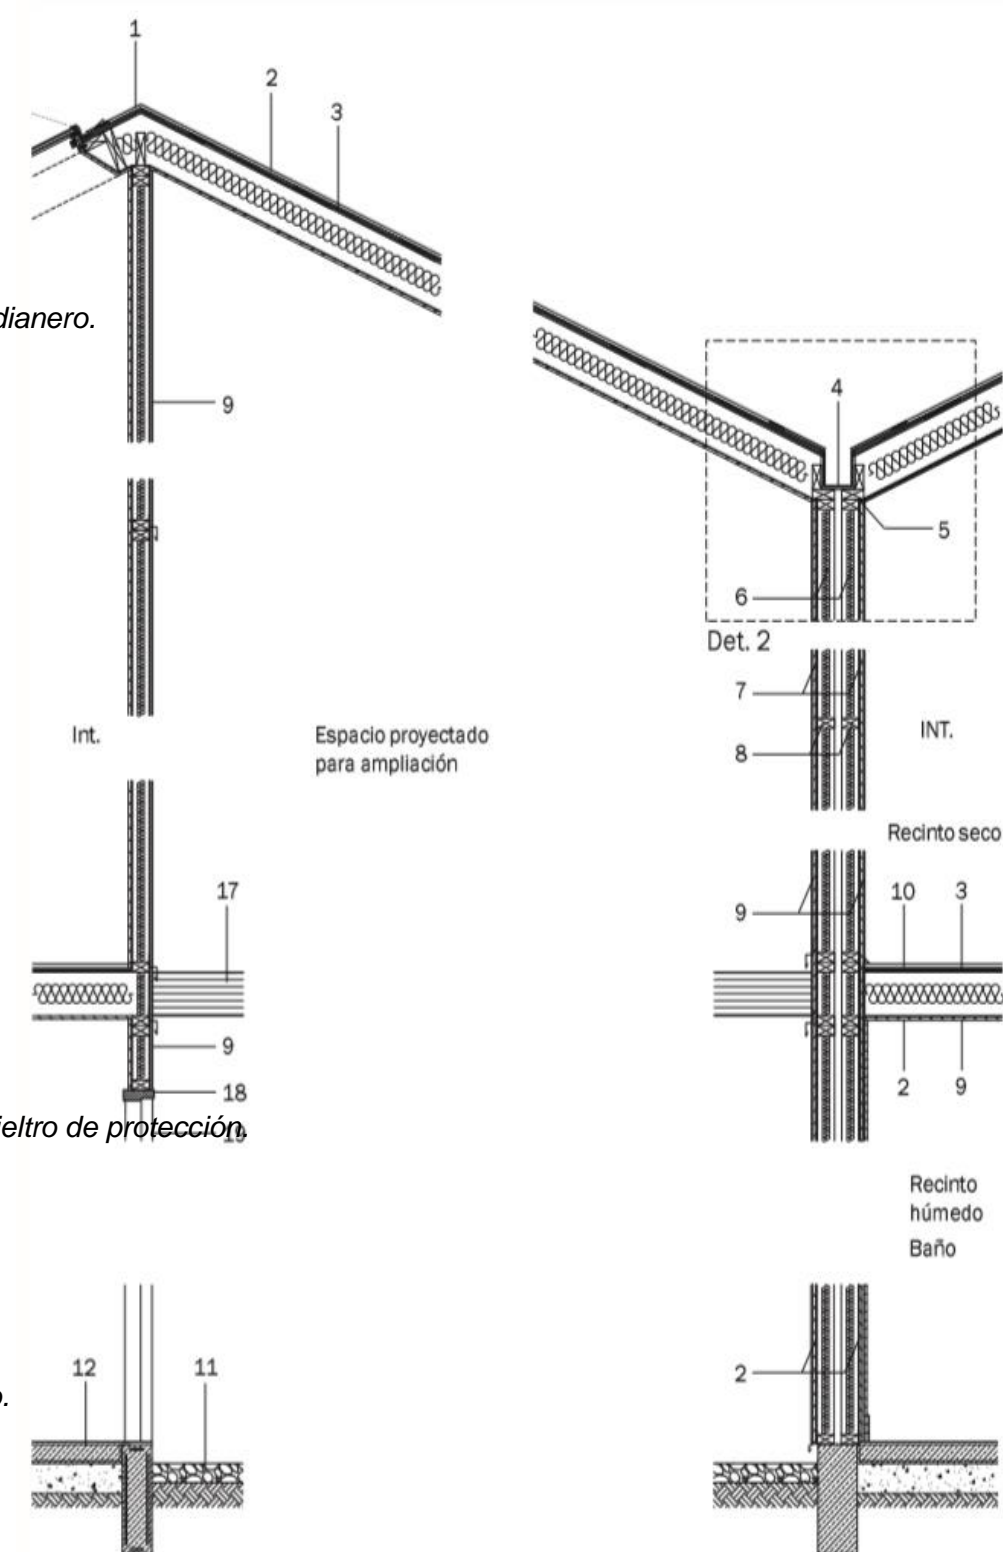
Fachada, Proyecto villa verde, Chile. 2021 editorial Arquitectura Viva SL
